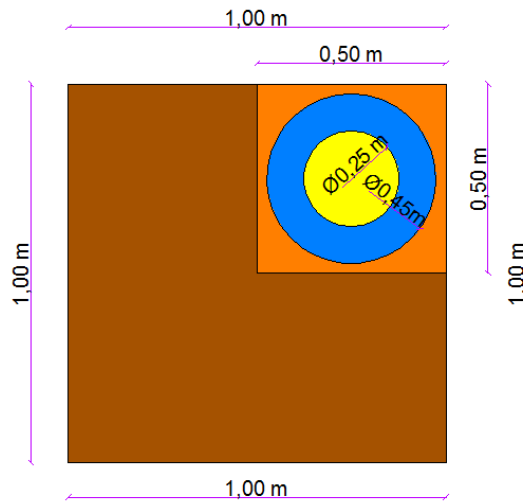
Planta de la gaveta, pozo de ensayo e infiltrómetro
